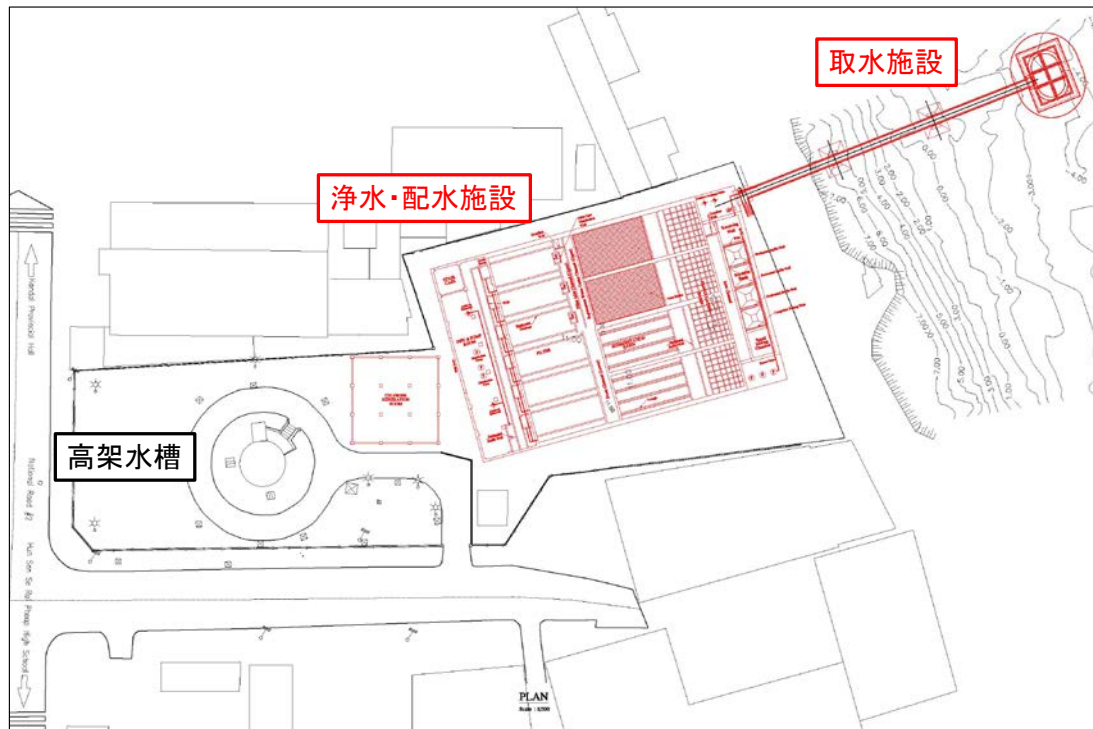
コンパラター施設の概略設計における平面配置図（案）
